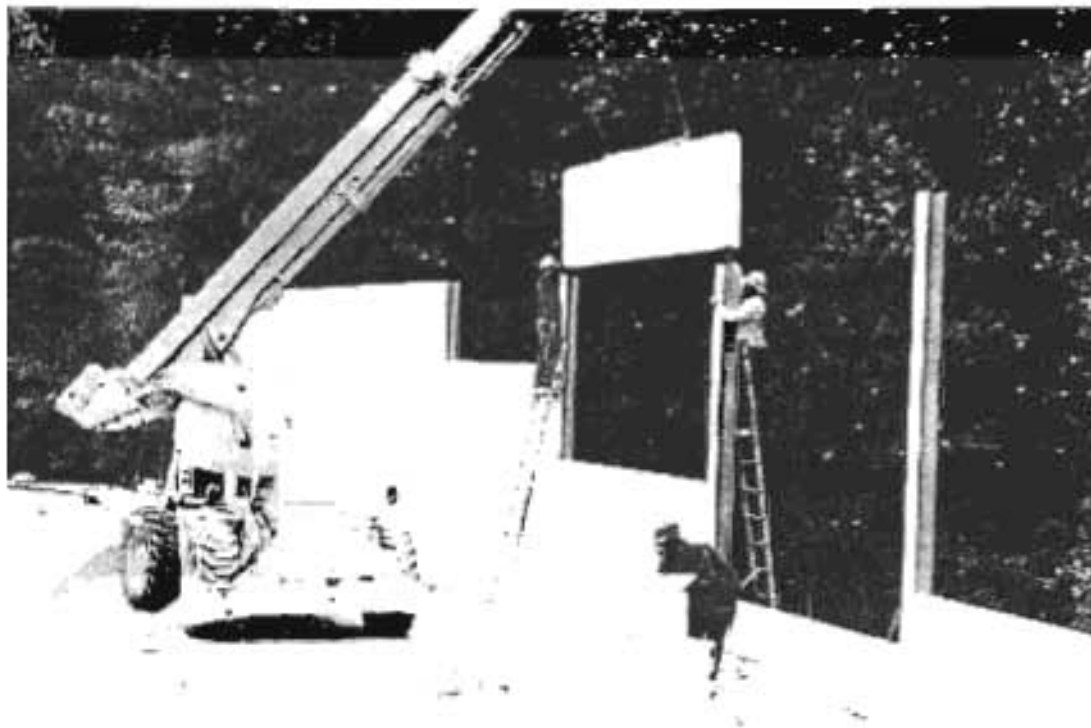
Paneles de nuevos materiales para el aislamiento acústico
